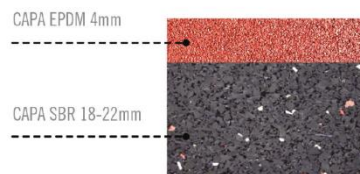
CAPAS DEL PAVIMENTO A BASE DE CAUCHO
